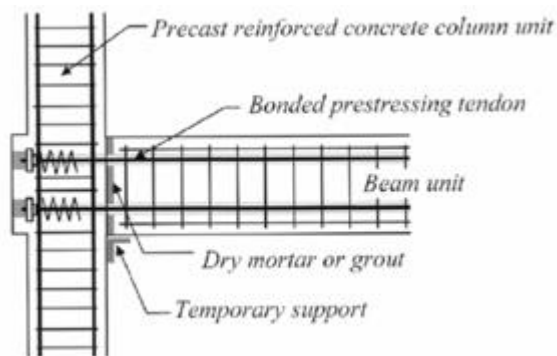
Vigas prefabricadas postensadas entre columnas (Blandón & Rave, 2016).
